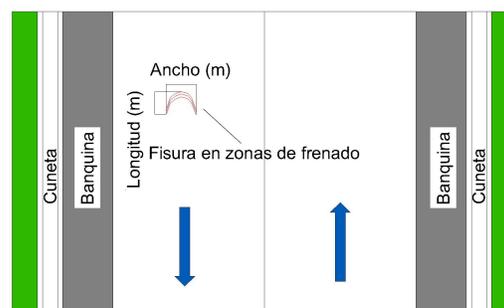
Fisuración por deslizamiento de capas (FDC, Unidad de medida: m², Penalidad: m²-carril)
